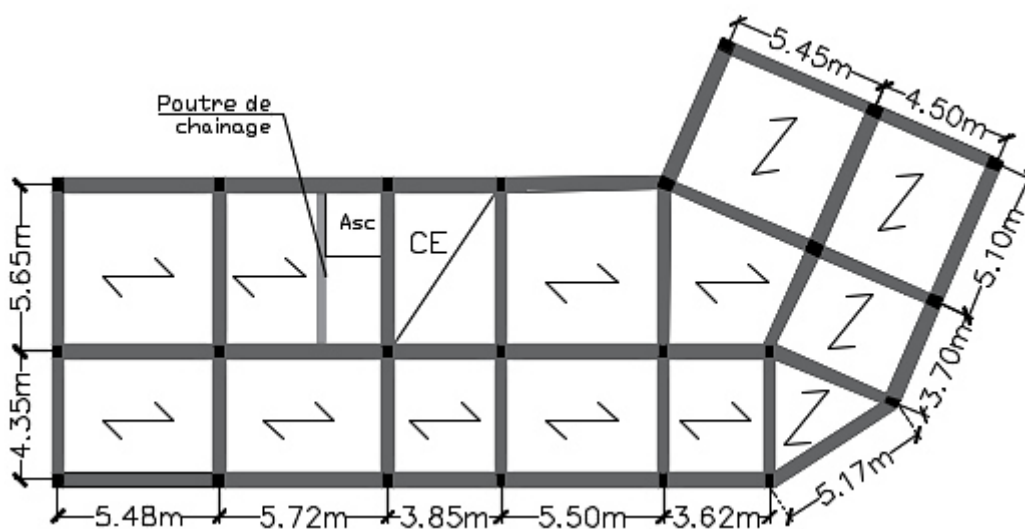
Schéma de disposition des poutrelles des planchers étage courant et terrasse.
